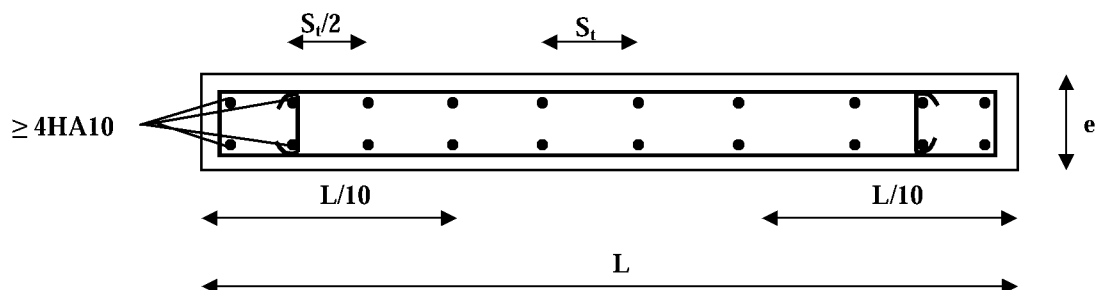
Disposition des armatures verticales dans les voiles.
